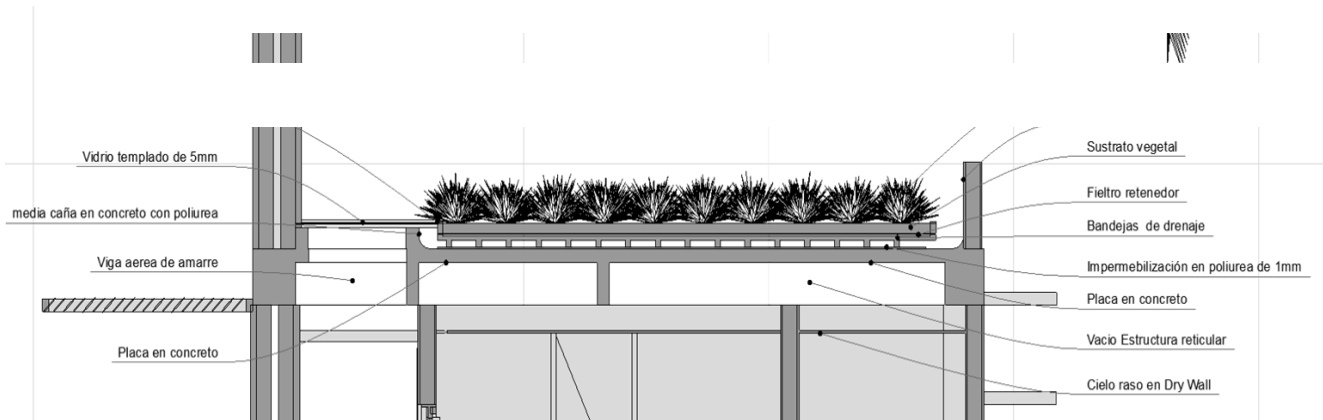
Corte de cubierta, sistema de implantación de cubierta verde Fuente: Autor
